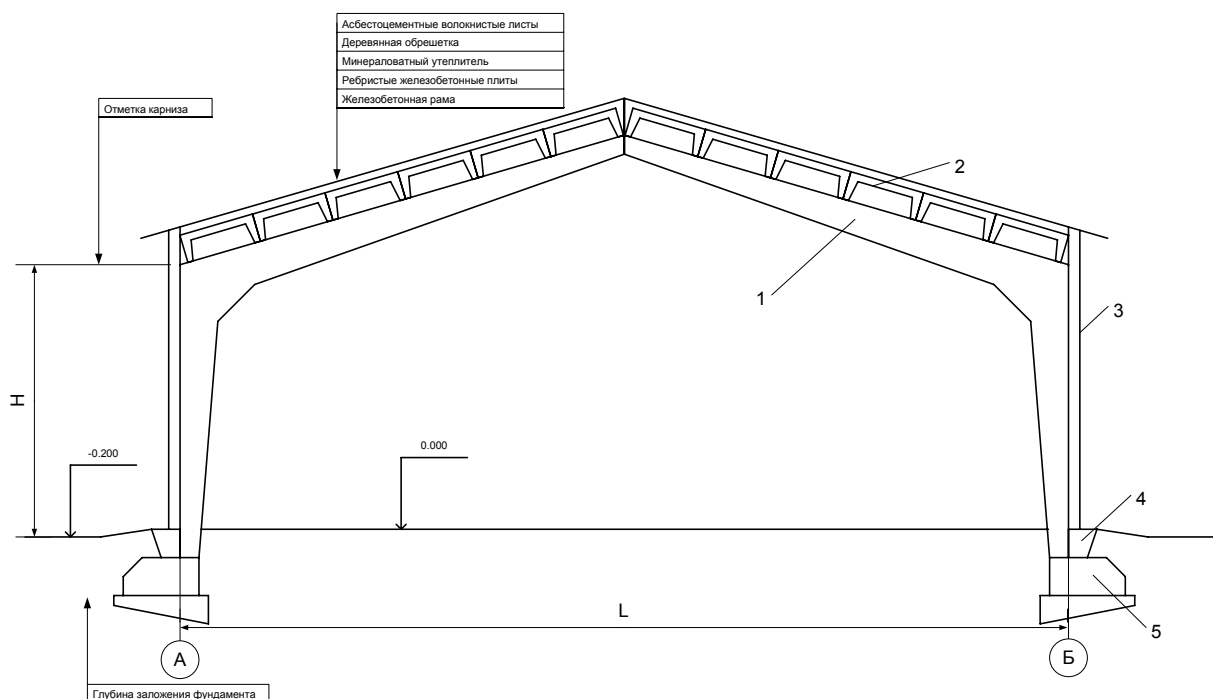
Схема поперечника здания: 1 – полурама; 2 – плиты покрытий; 3 – стеновая панель; 4 – фундаментная балка; 5 – фундамент
